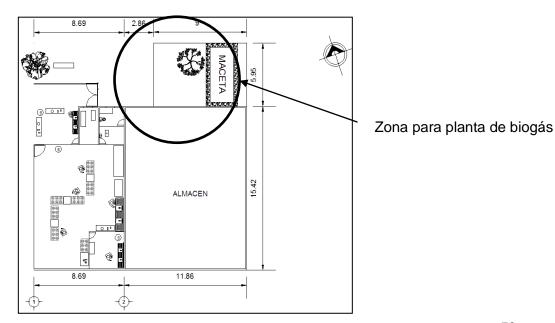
Croquis del restaurante de la Facultad de Química y la zona de estudio de la planta de biogás
